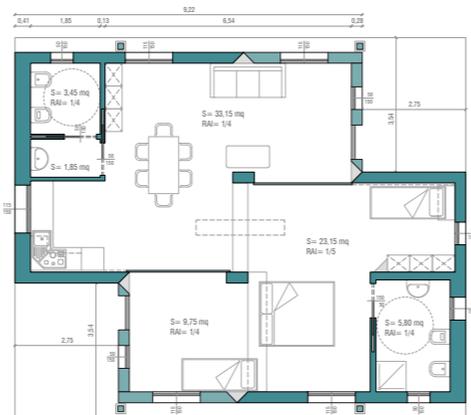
Pianta modulo doppio con pareti aperte - variante 2. Scala 1:200
